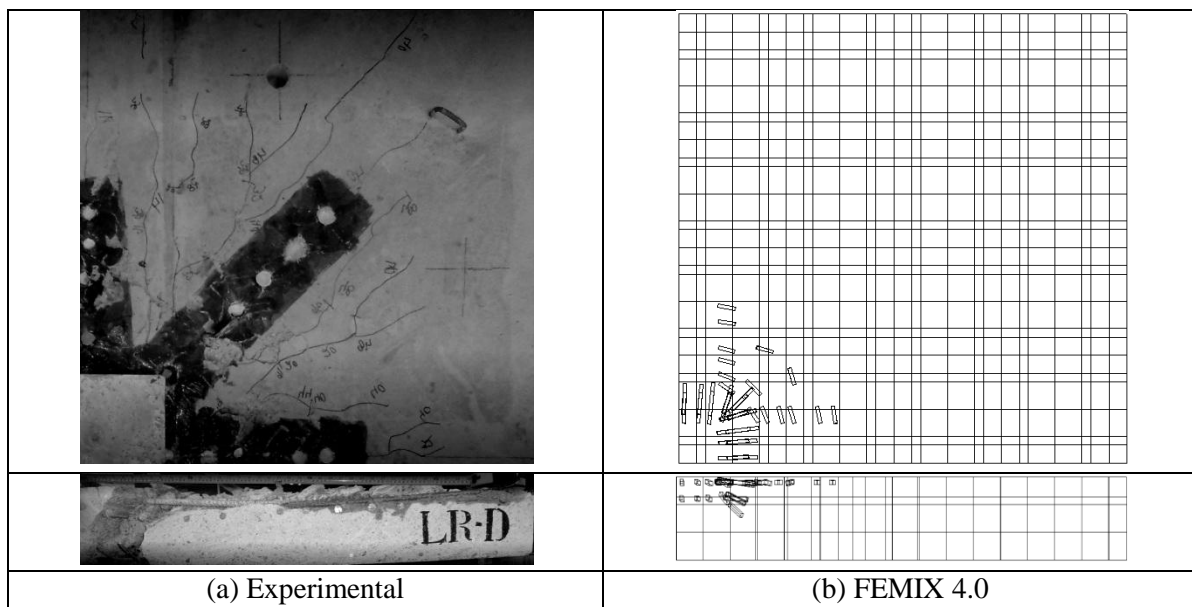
Padrão de fissuração - LR-D (FEMIX 4.0)
